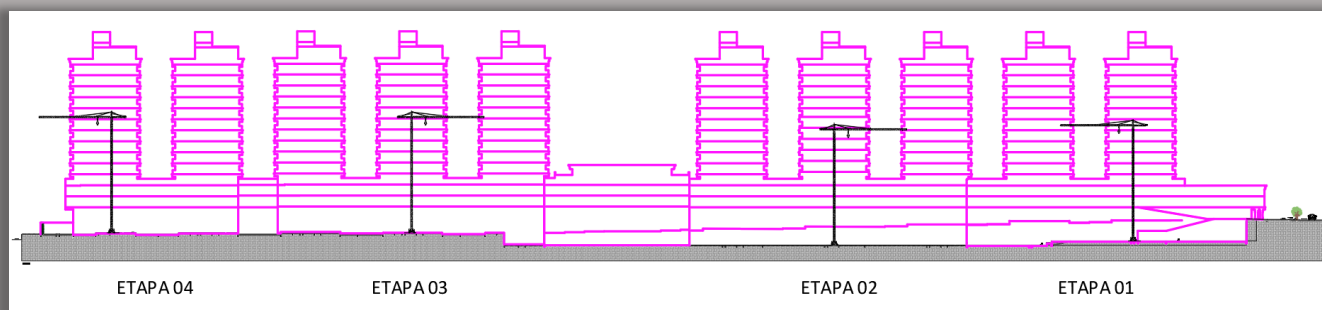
SECÇÃO CORTE DO TERRENO SEM SUBSOLO.
